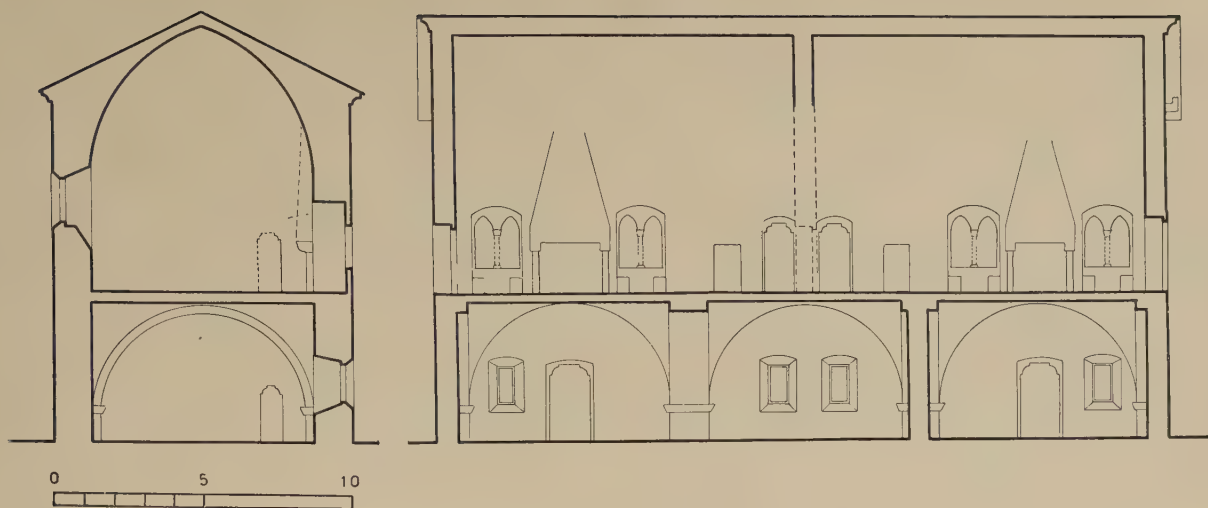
Sezione trasversale e sezione longitudinale della costruzione
